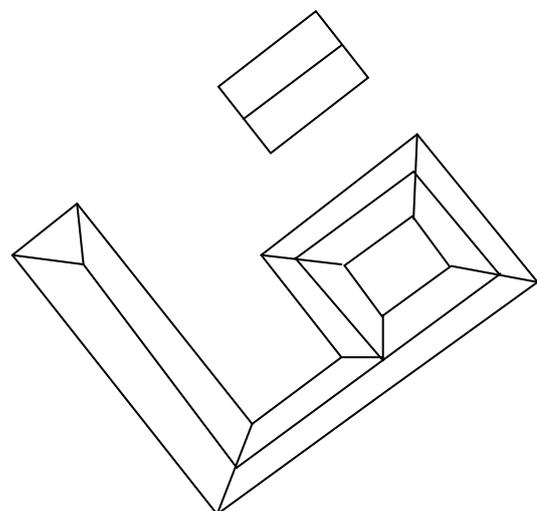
Blick auf das Dach bzw. Grundriss mit durchgängiger First- und Trauflinie
